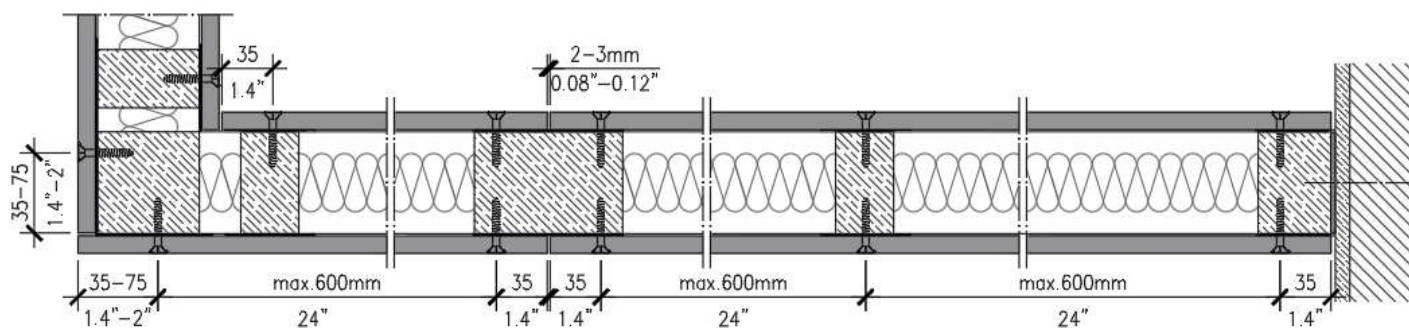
Secção horizontal da parede, estrutura de madeira
